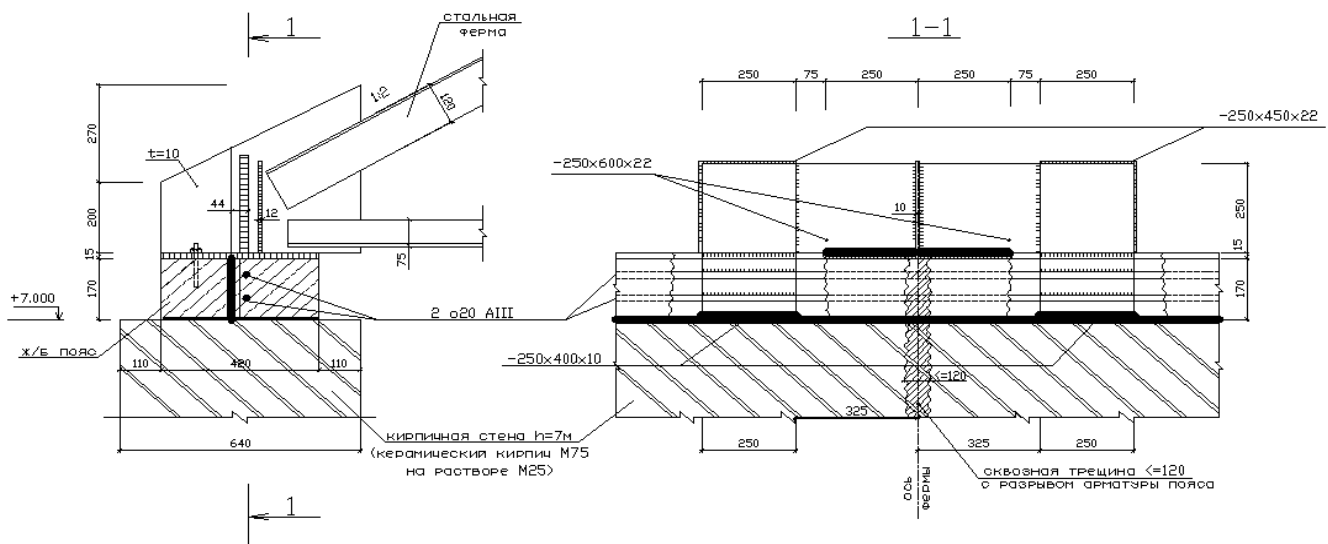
Восстановление железобетонного пояса наружных кирпичных стен зрительного зала дома культуры «Октябрьский»
